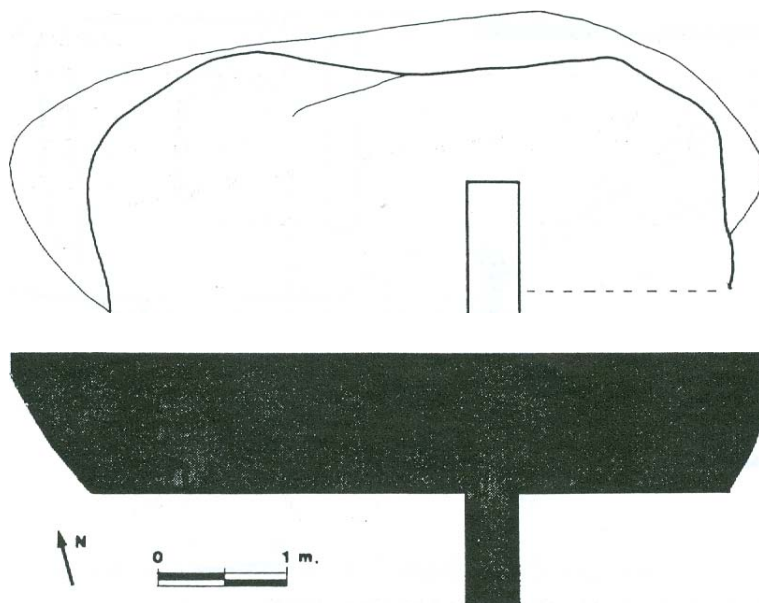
Croquis del alzado y planta de la estructura de San Mamede.
